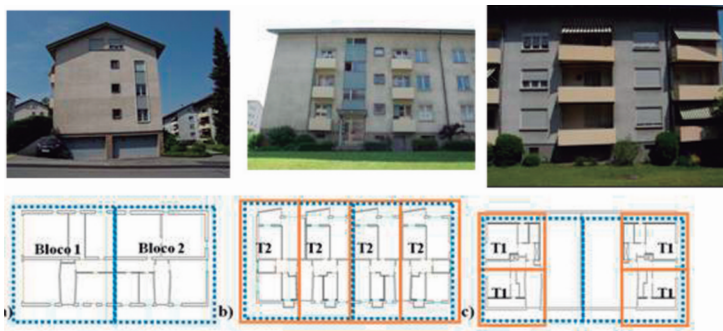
Caso de estudo 2 - Fachada a SE, NE e SW, respetivamente
